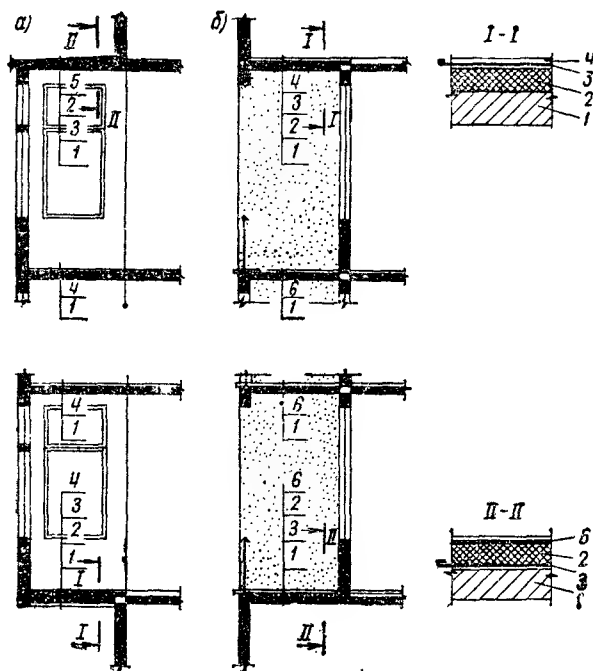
Схемы конструктивных решений перекрытий в эркерах и лоджиях
